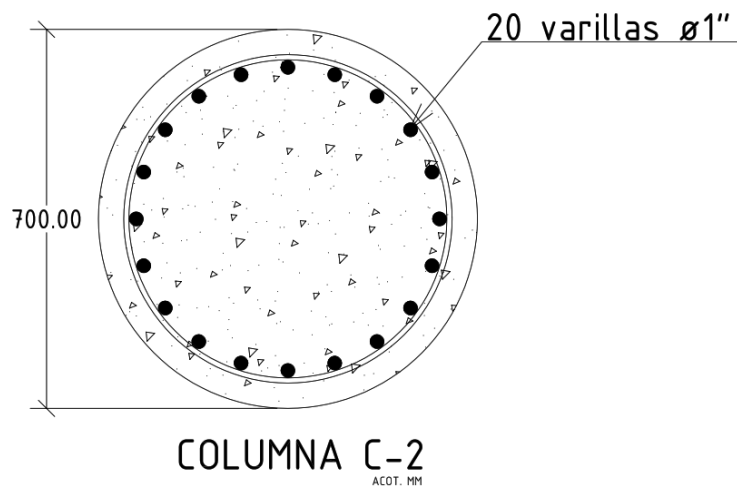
Vista esquemática de la sección. (Fuente autoría propia, 2019)
